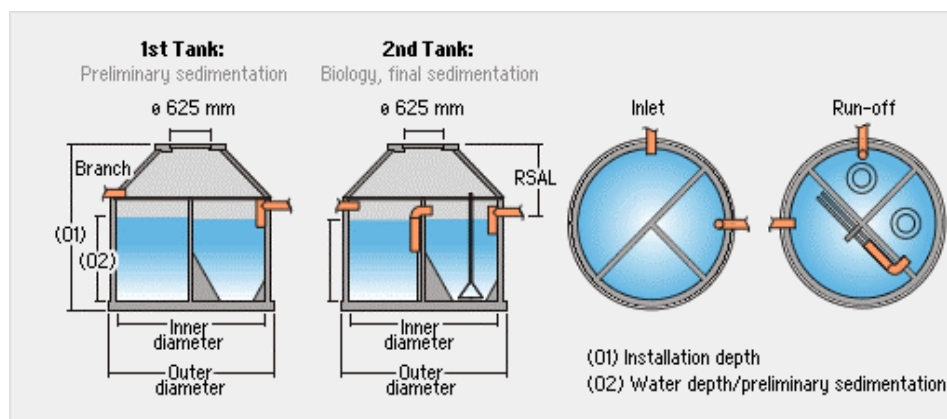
Planta de tratamiento WBS Clean Basic
